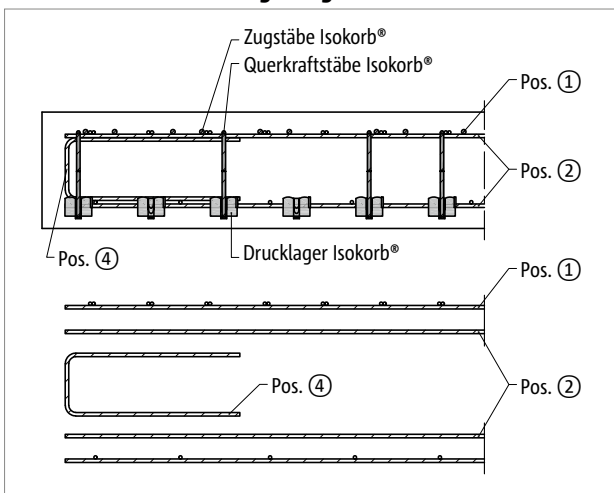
Schöck Isokorb® XT Typ KL: Bauseitige Bewehrung balkonseitig im Schnitt A-A; Pos. 4 = konstruktive Randeinfassung am freien Rand senkrecht zum Schöck Isokorb®
